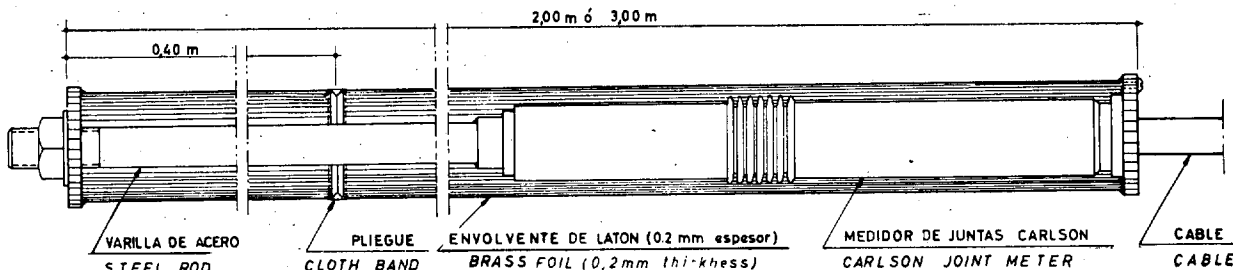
Extensómetro de cimentación (envolvente de latón seccionada).
